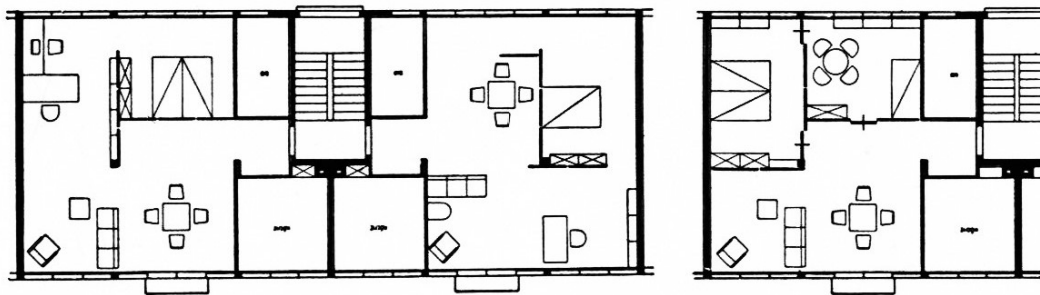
Grundriss Apartmenthaus Mies van der Rohe
